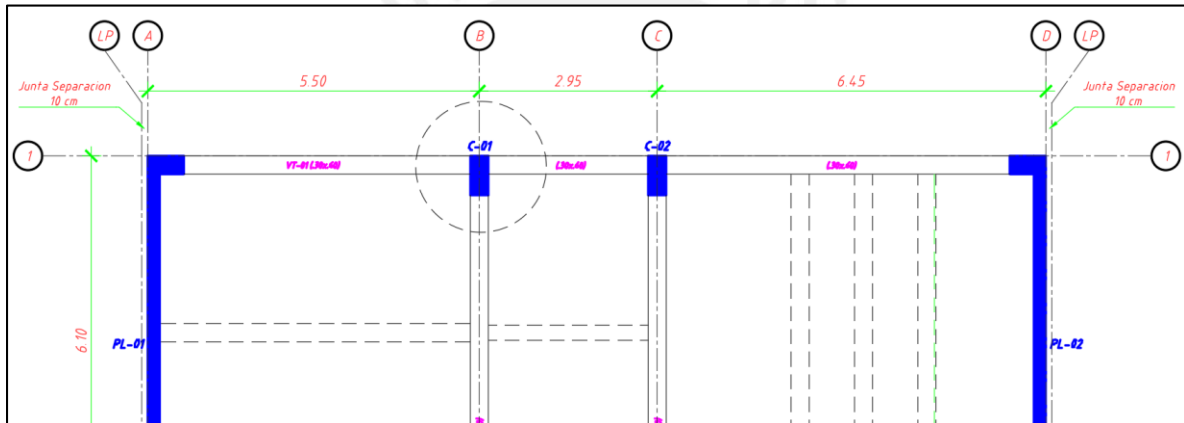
Columna C-01(0.30x0.65) en el plano de encofrado. Primer piso.
